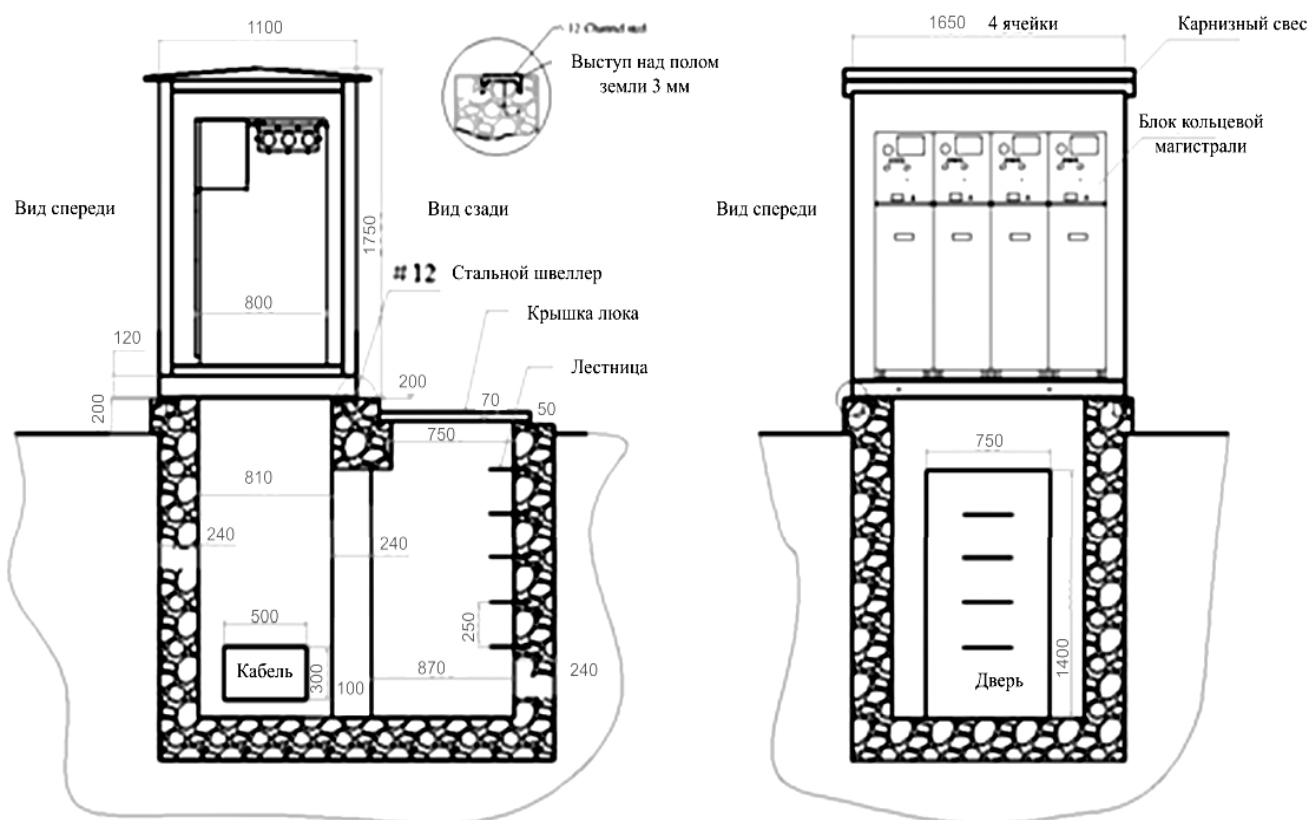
Схема монтажа фундамента электрической подстанции наружной установки из четырех ячеек RTN24-L
